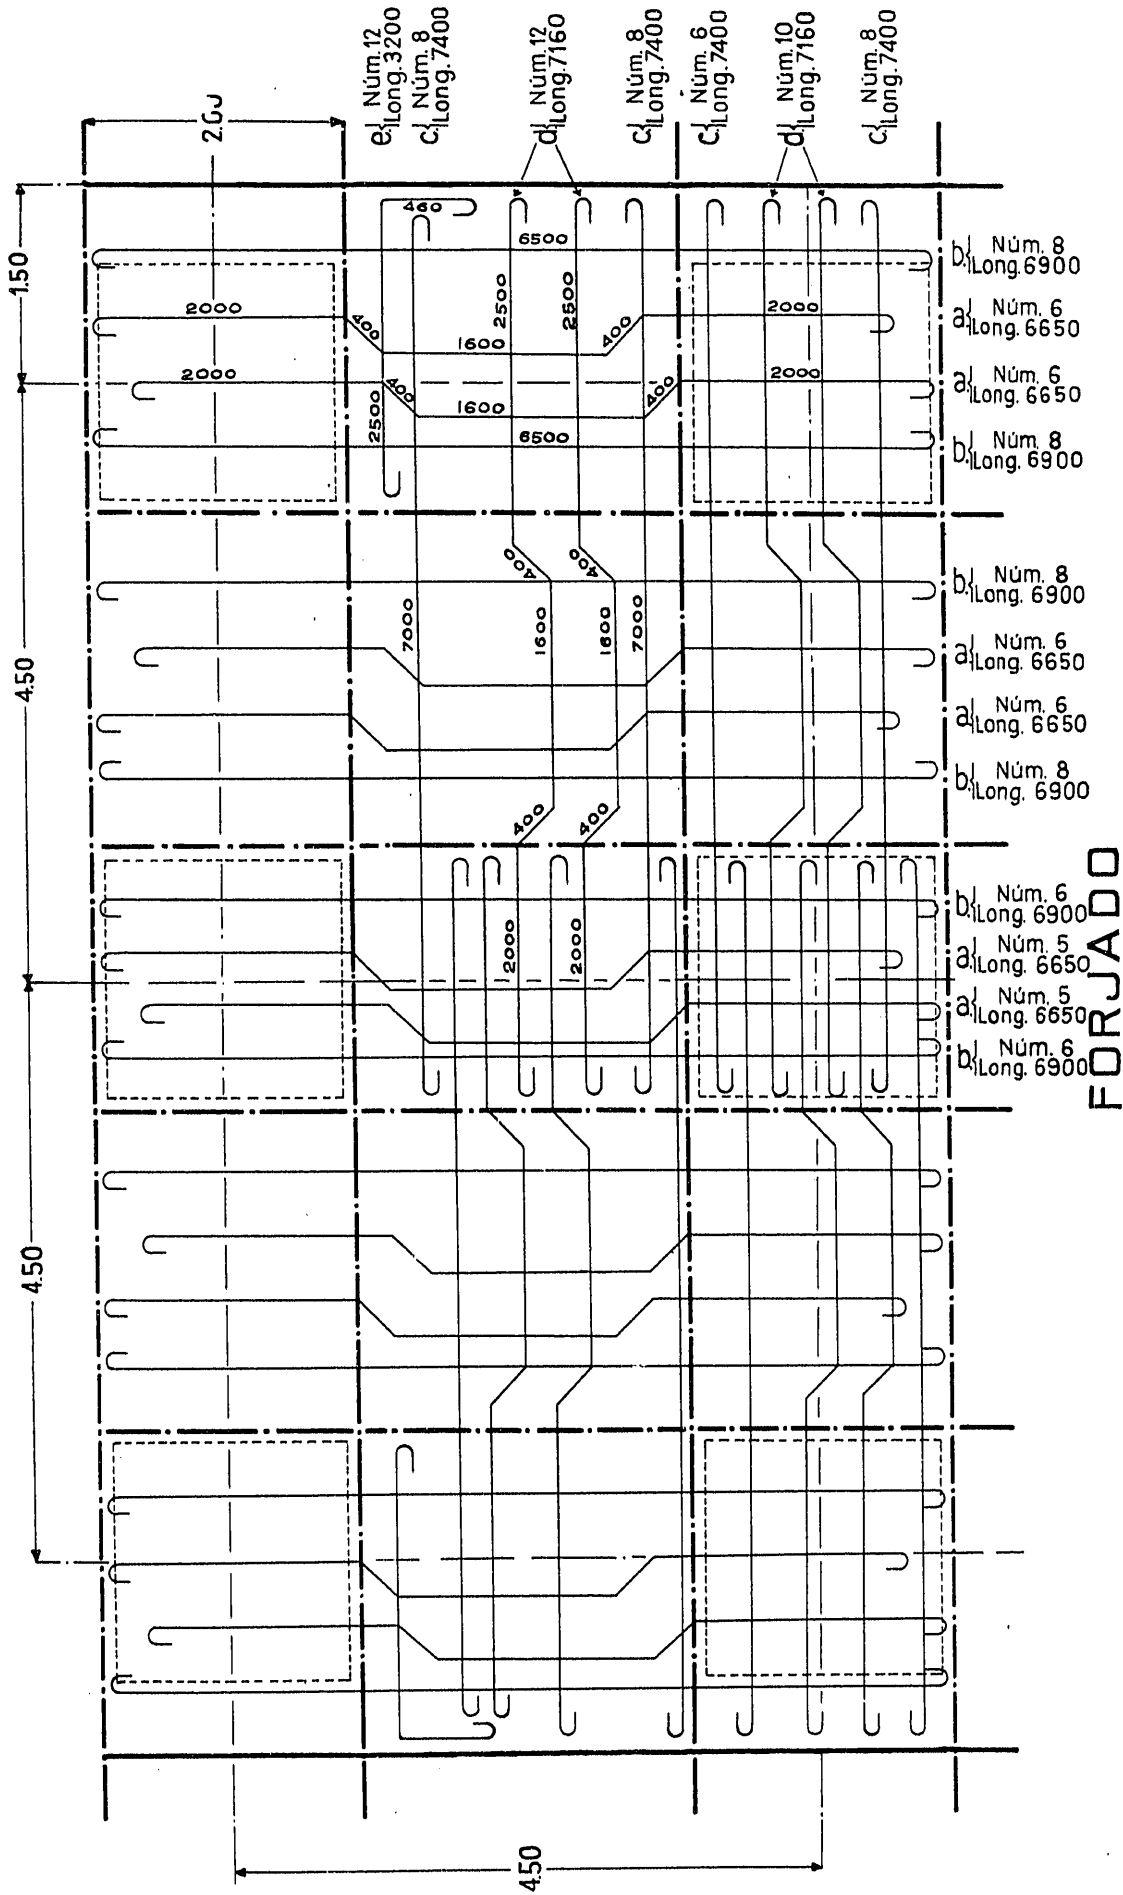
Detalle del armado de la losa en el modelo de tres vías
